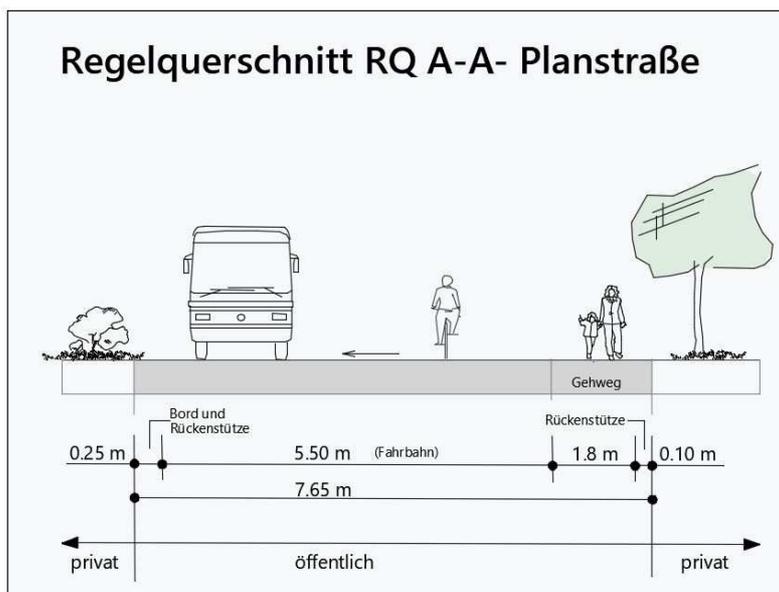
Regelquerschnitt der öffentlichen Planstraße
